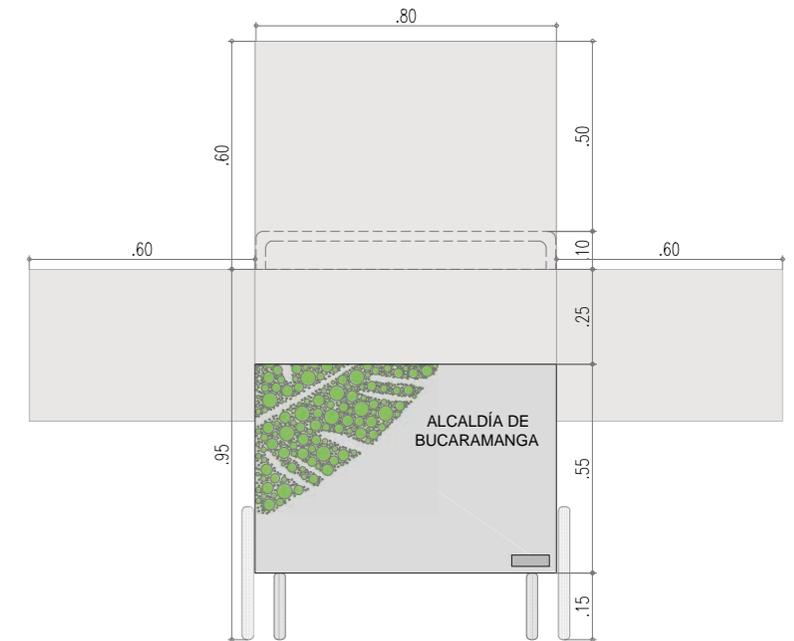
Fachada puesto de venta semi-estacionario tipo 3. Esc 1:20
